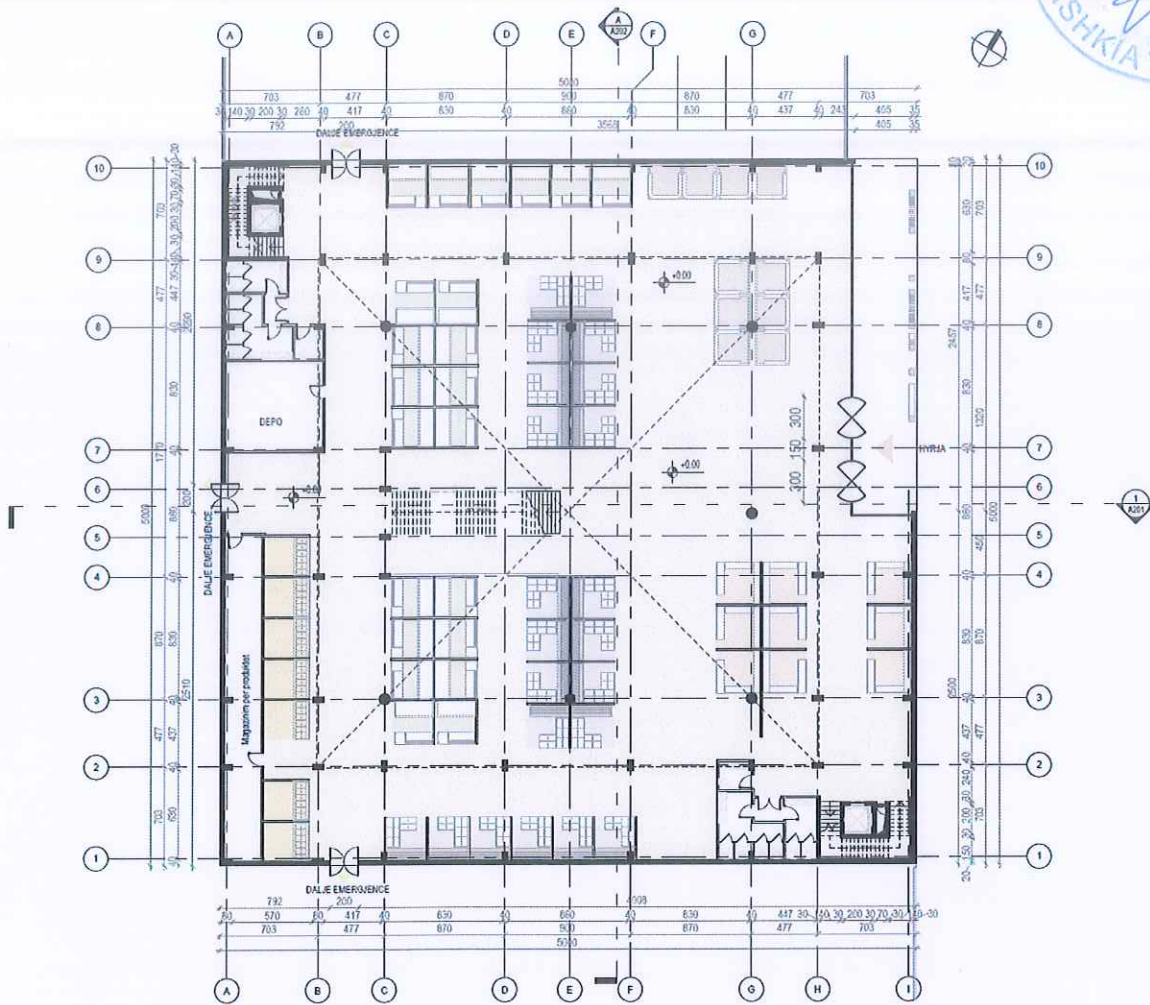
Planimetri "Qendër Biznesi" – Kati 0
